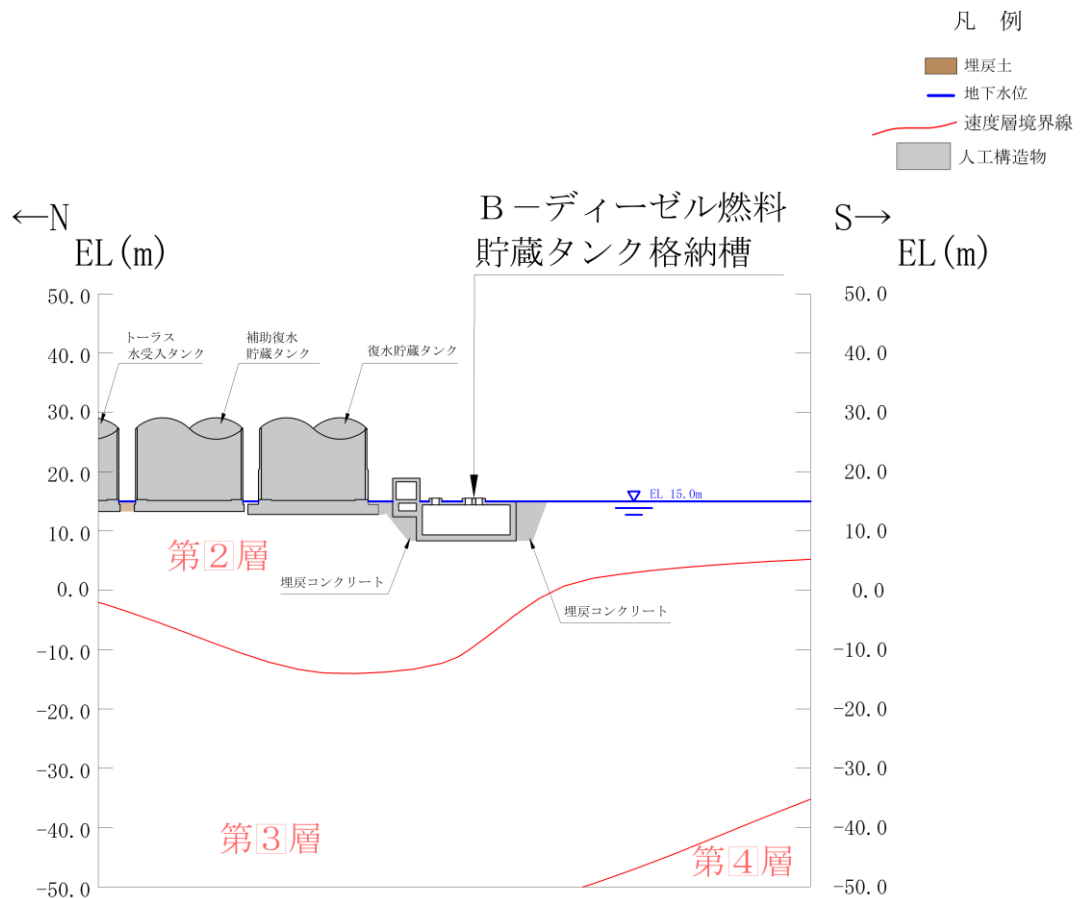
B-ディーゼル燃料貯蔵タンク格納槽 評価対象断面図 (B-B断面)
